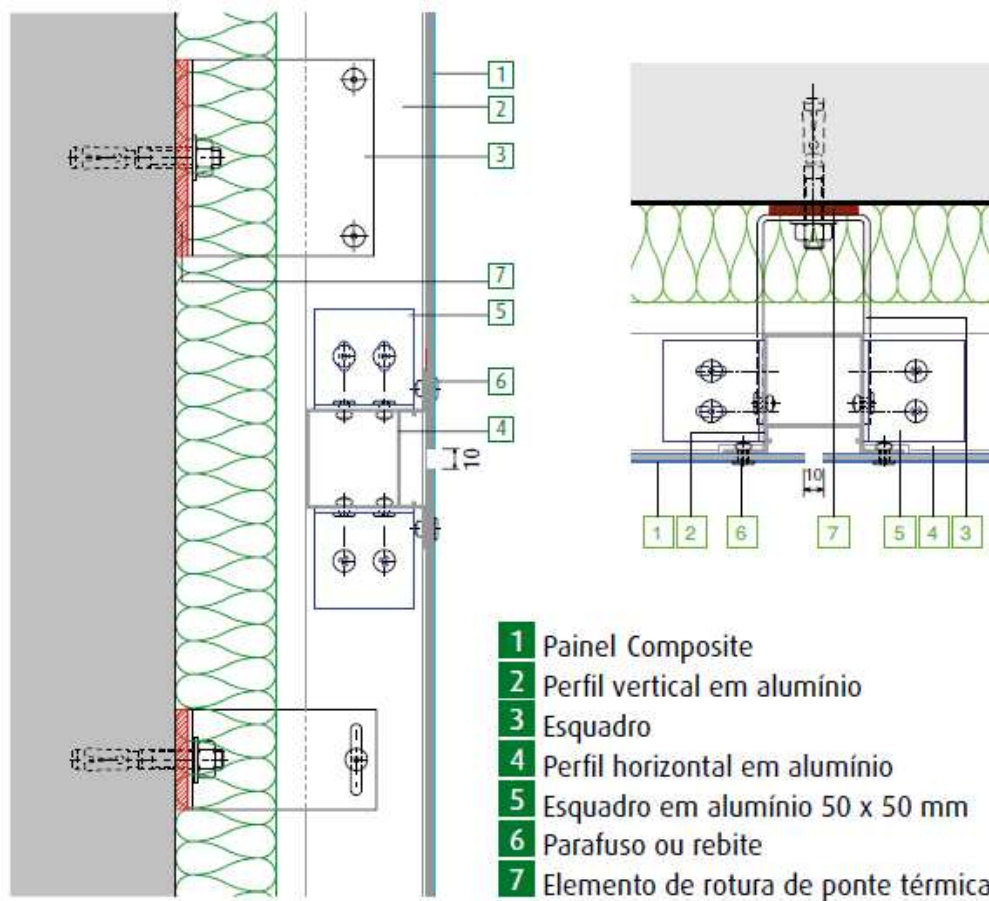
Pormenor construtivo do sistema cravado/aparafusado (corte transversal e horizontal)
